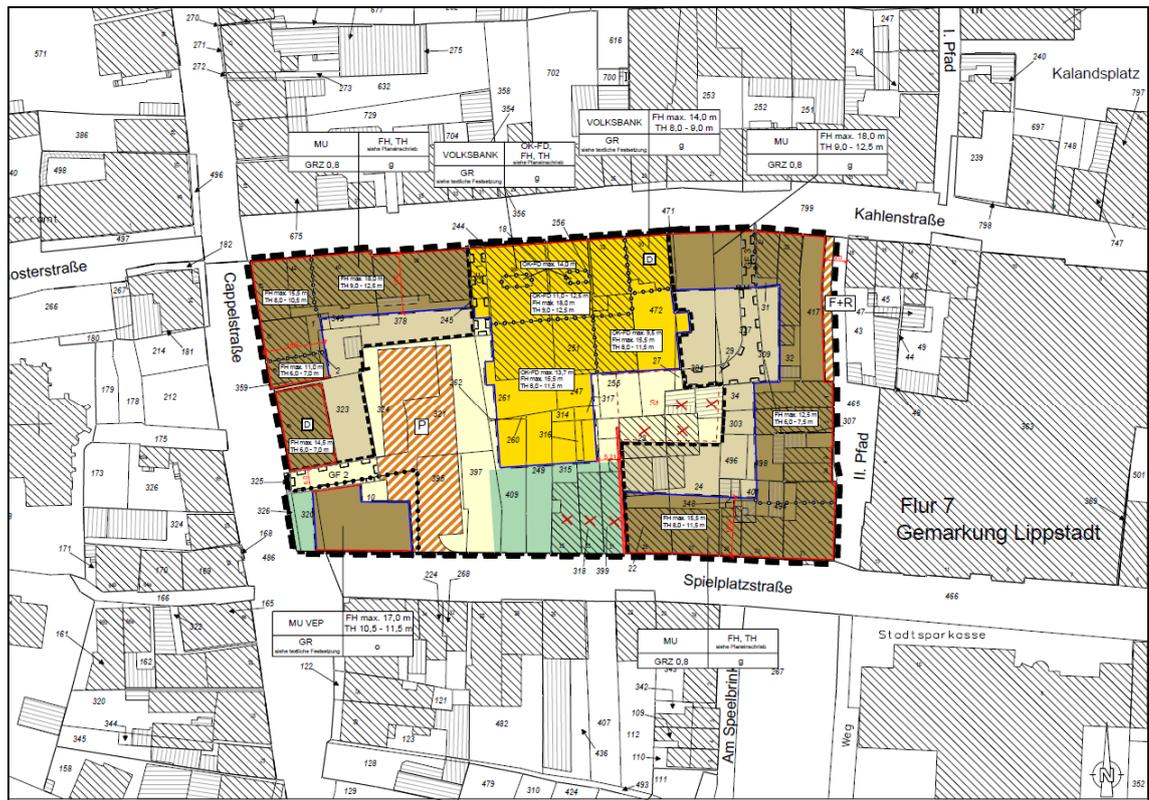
Ausschnitt Lageplan (o. Maßstab) [20]
